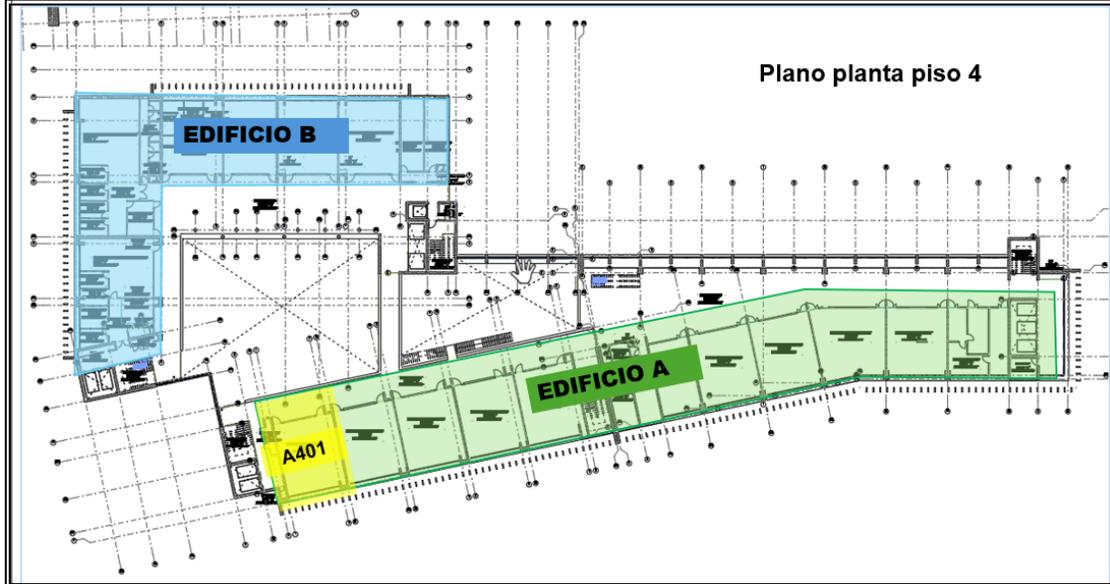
Plano general del piso 4 Sede Bellavista – AutoCAD
